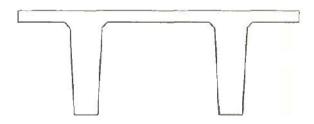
Poutre de section en auge renversée, ou en pi
